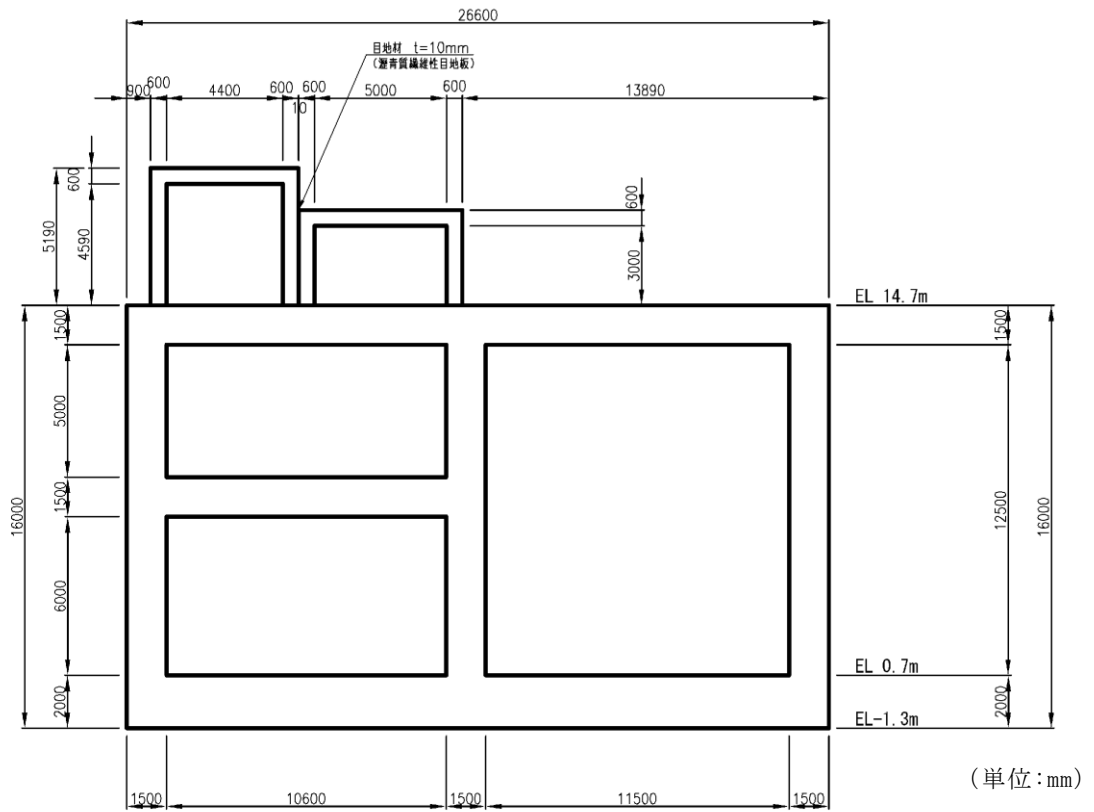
(3) 低圧原子炉代替注水ポンプ格納槽 断面図 (C-C 断面)
